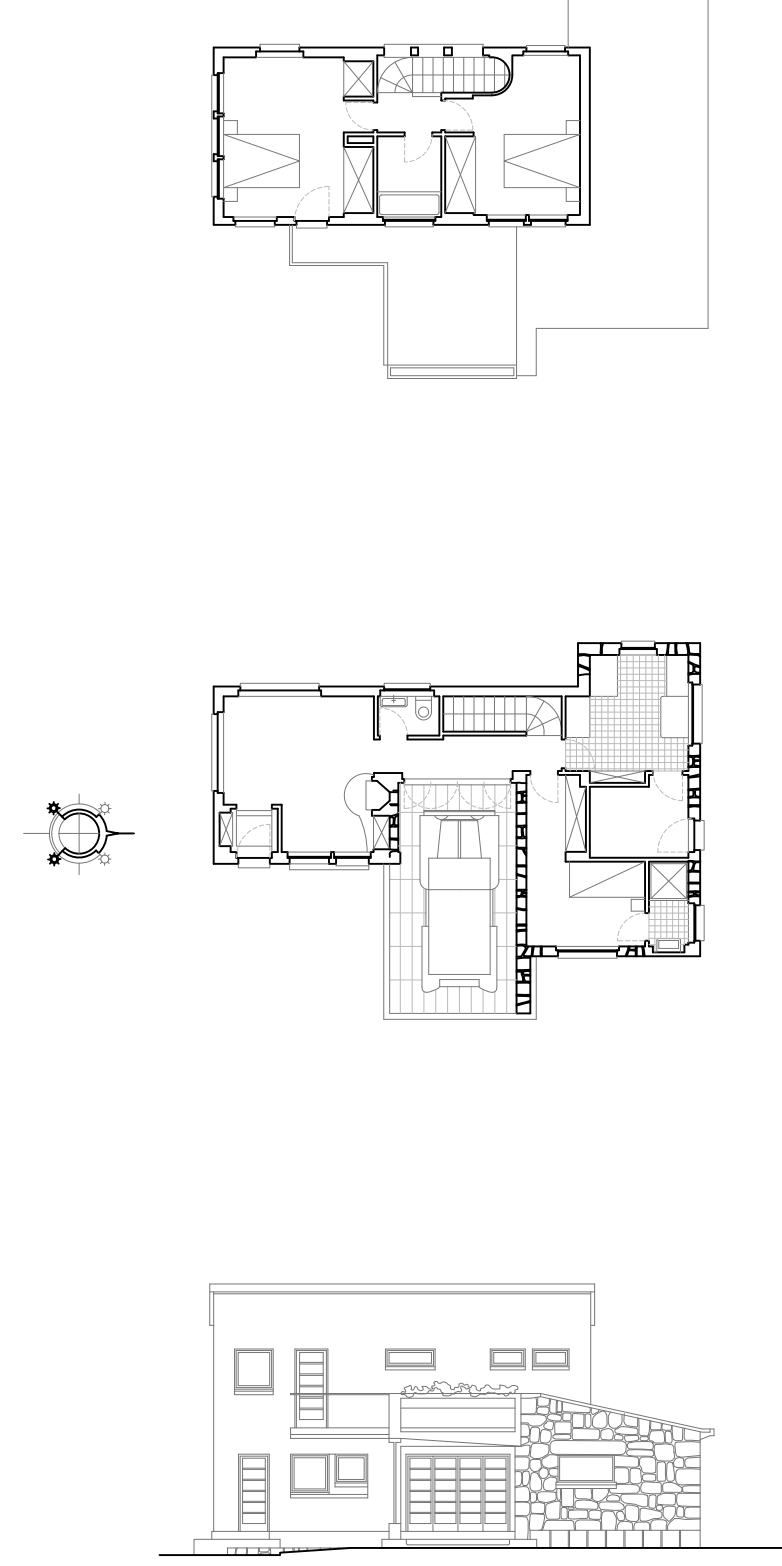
Planta de primeiro piso, planta de rés-do-chão e alçado nascente da Casa Artur Aires - escala 1.200.
